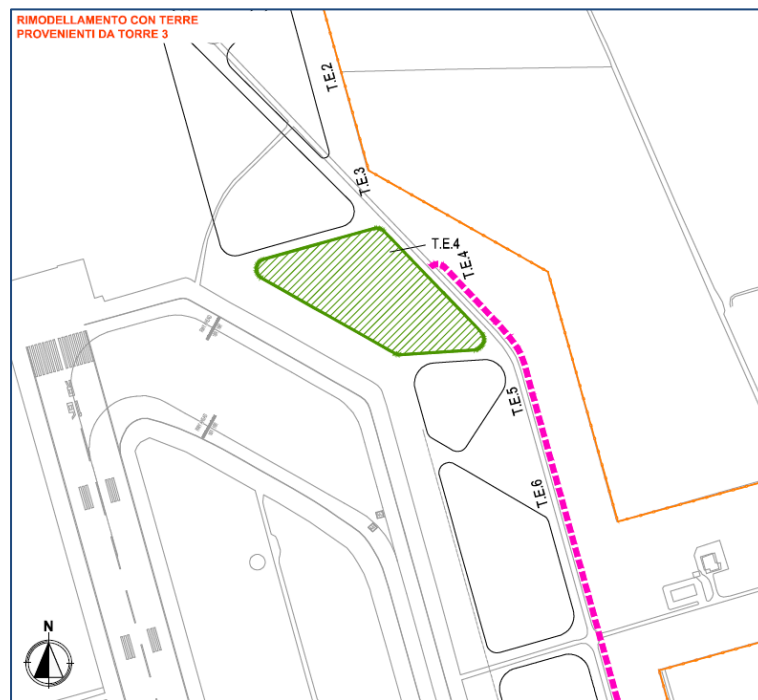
Ubicazione planimetrica del terrapieno di interesse progettuale, T.E.4
